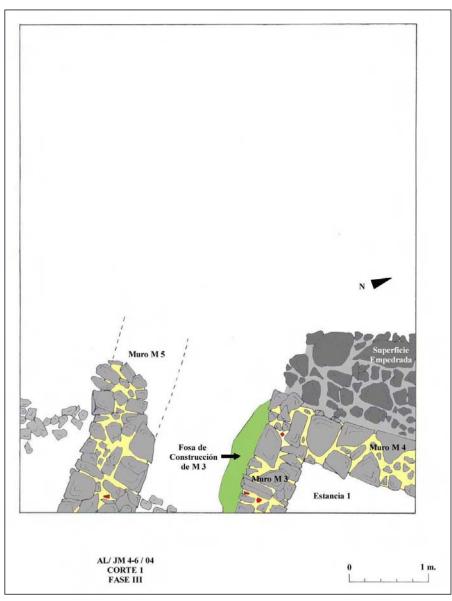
Planta del Corte 1 con la ubicación de las estructuras asociadas a la fase II –época almohade-.
